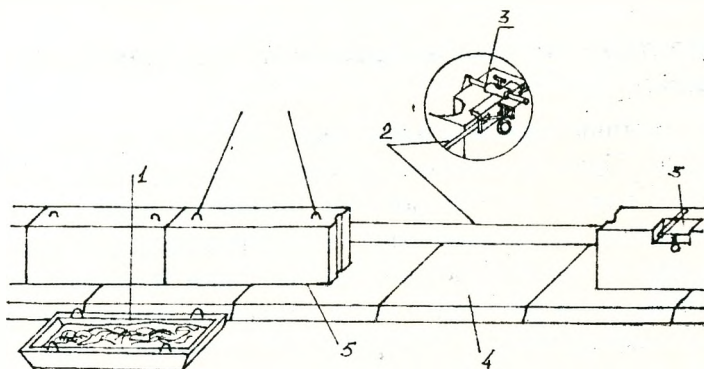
Монтаж фундаментных стеновых блоков.
